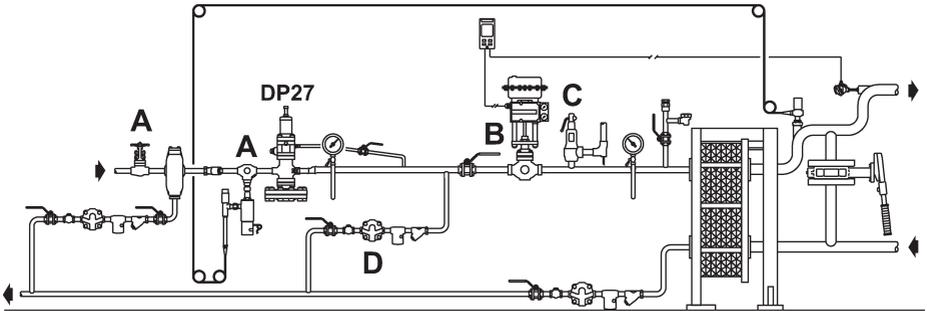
Posizionamento del riduttore rispetto alle altre apparecchiature
